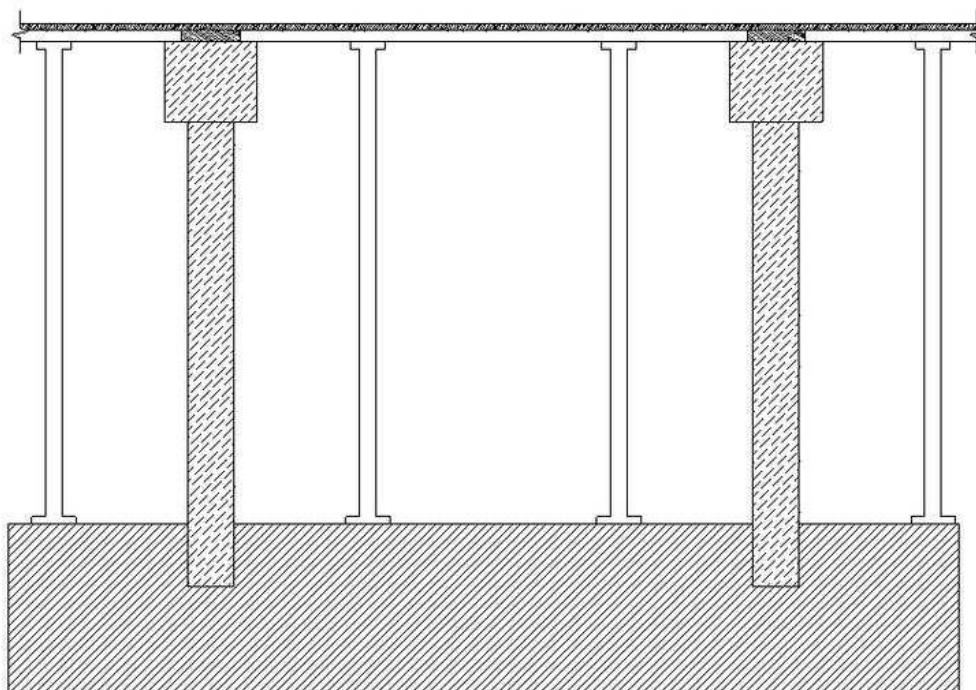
Схема усиления балок конструкций дополнительными деревянными опорами
